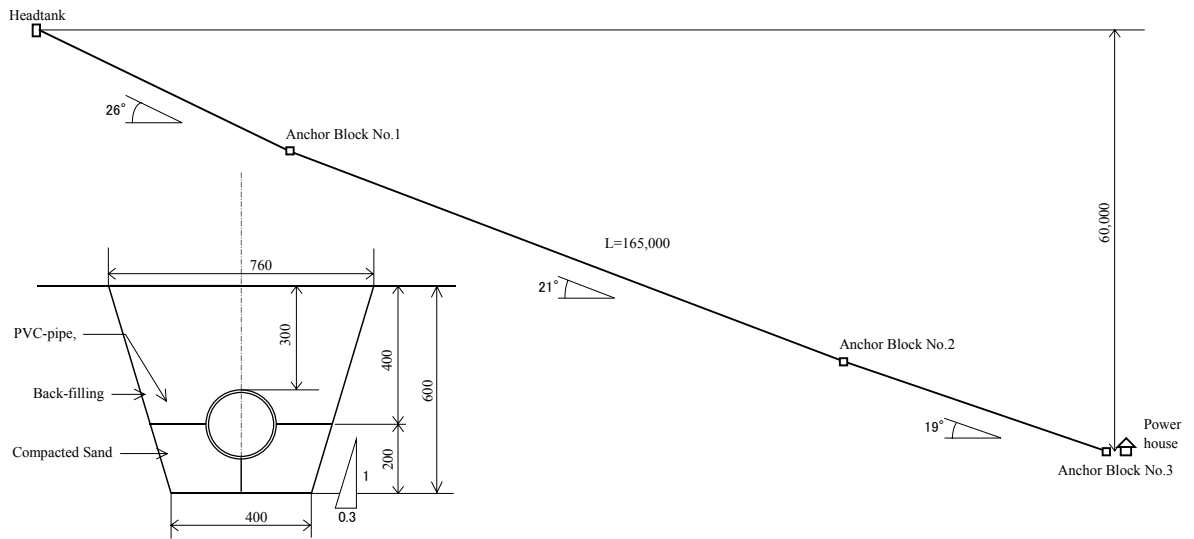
埋設式 PVC 水圧管路設計例 (縦断面図)
